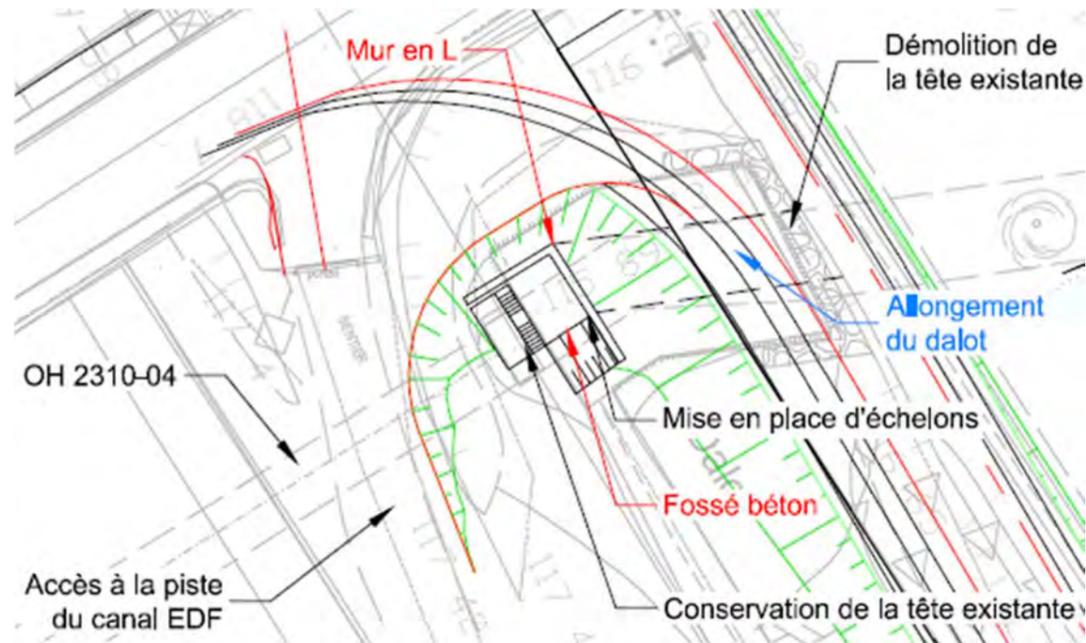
Allongement de l'ouvrage du Vabre du Talagard PI OH 2310-3 au niveau du siphon (source setec juillet 2019)
